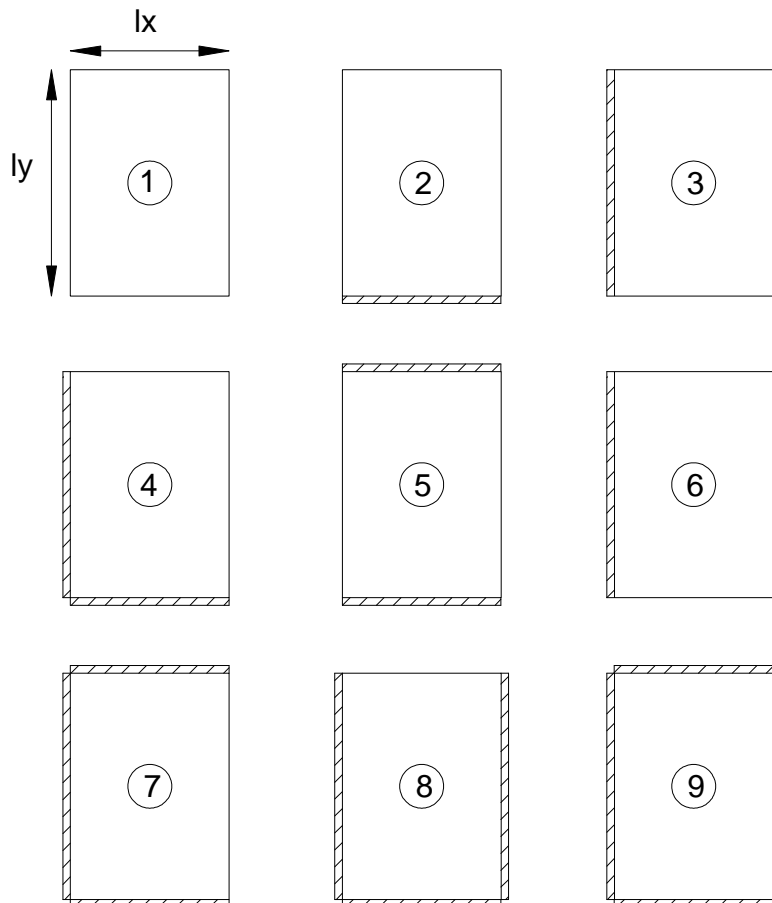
Condições de Apoio para Lajes Armadas em Duas Direções.
